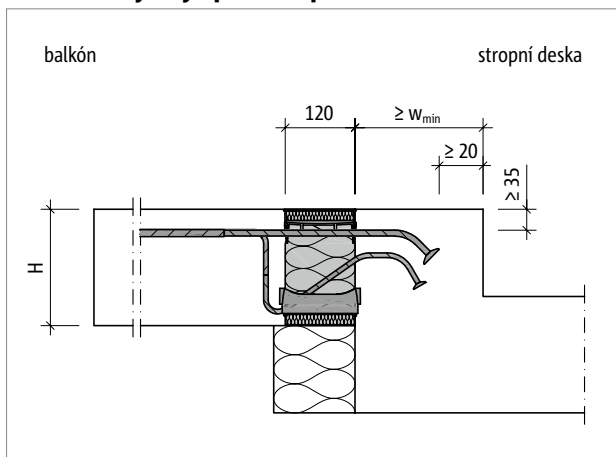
Schöck Isokorb® XT typ KL-U/KL-O: Balkón na zalomené fasádě
